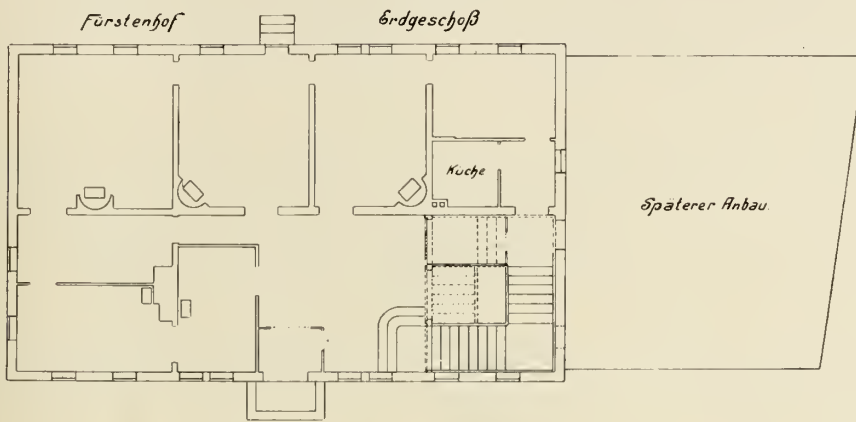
Hannover; Fürstenhof, Grundriß des Erdgeschosses.
